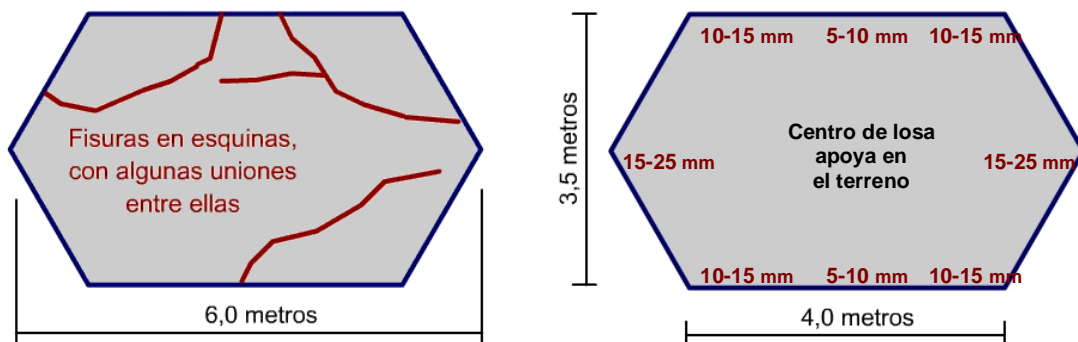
Caso 4 - Patrón de fisuras para losas hexagonales y alabeos medidos en las losas.
